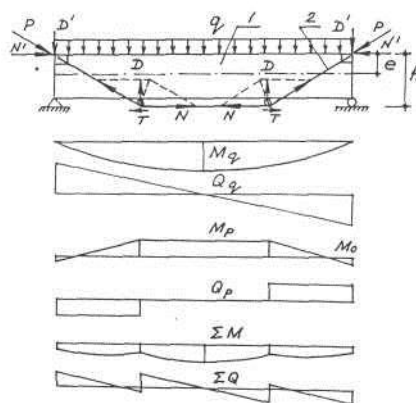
(1 — железобетонная балка, 2 — шпренгель)
